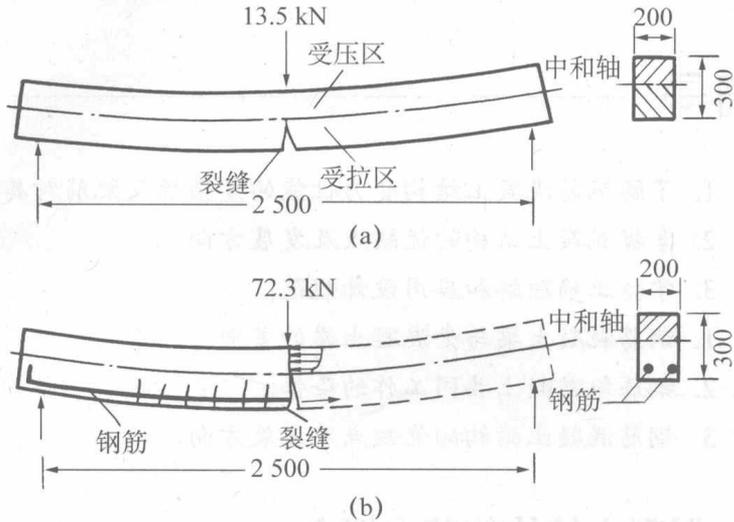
素混凝土与钢筋混凝土简支梁的破坏情况对比
